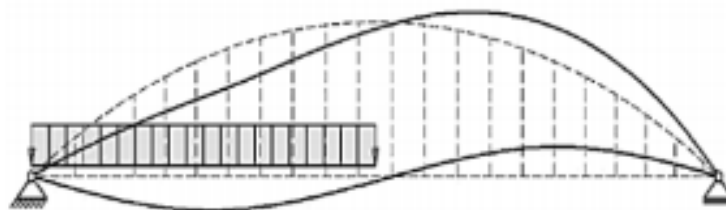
Configuração da deformada de uma solução de pendurais verticais [10]
